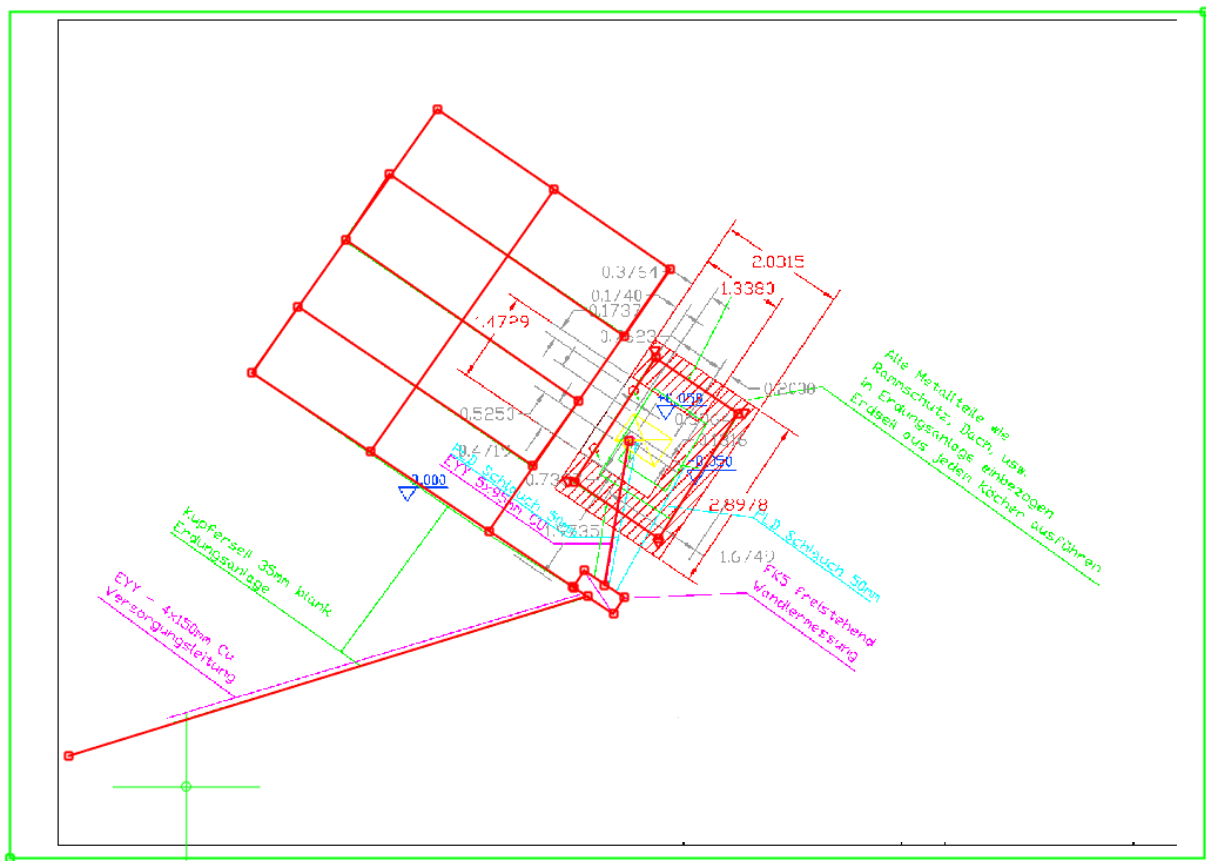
Grundriss Variante 6 (vgl. [36])
